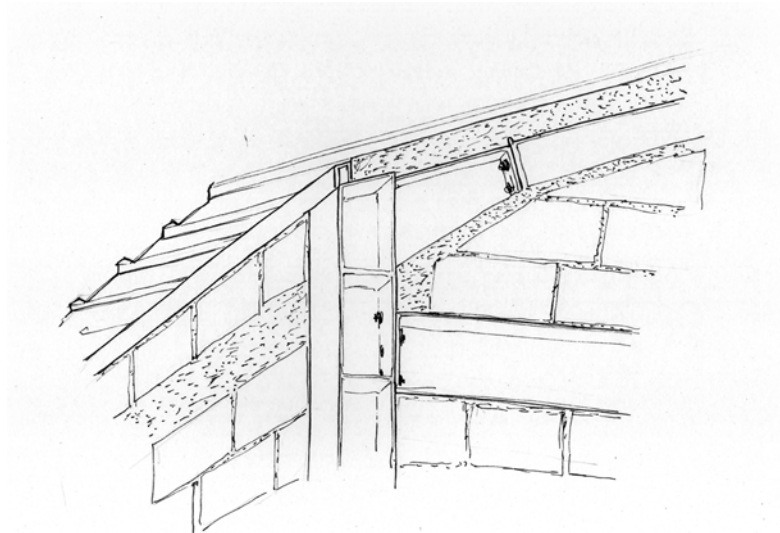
Detalle de del encuentro entre estructura metálica, cerramiento de bloque de hormigón y cubierta de chapa grecada.
